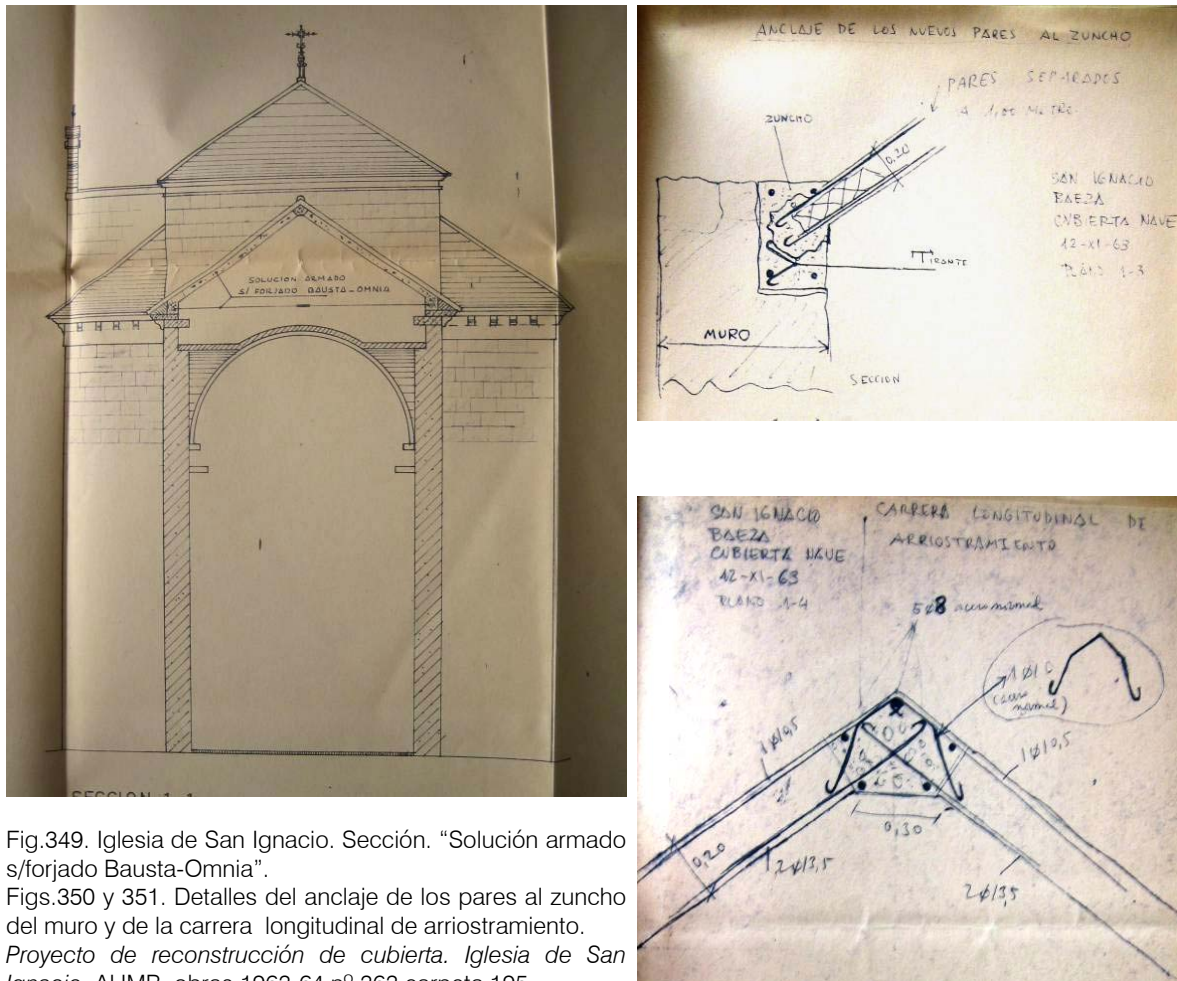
Iglesia de San Ignacio. Sección. "Solución armado s/forjado Bausta-Omnia".
